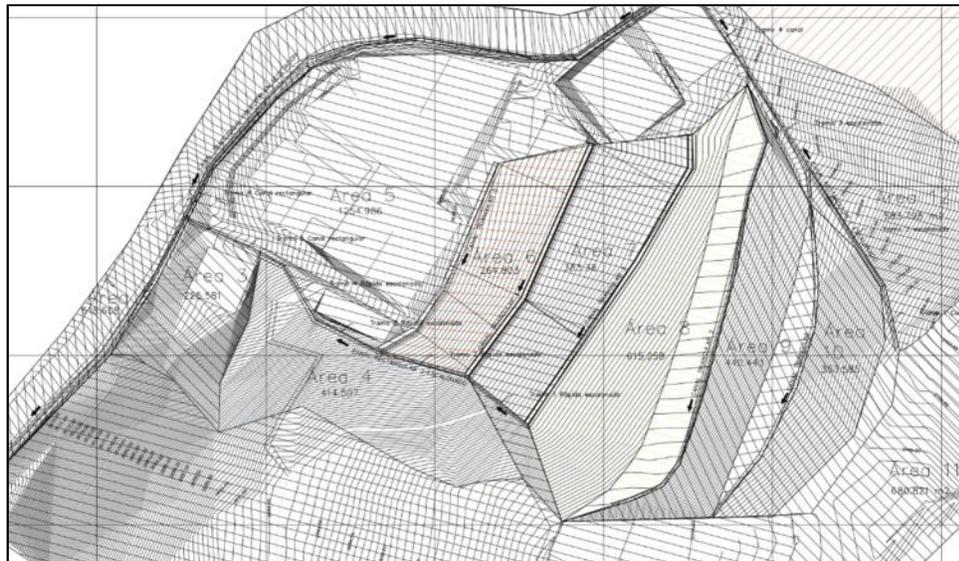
plano obras hidráulicas (ver anexo 6.1)
